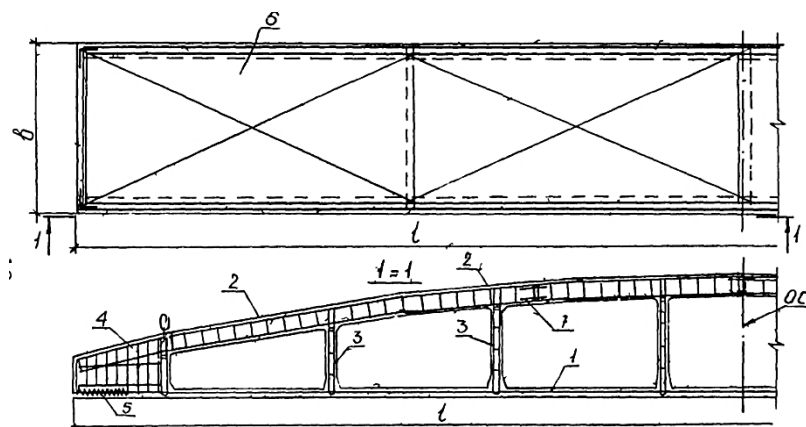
Схема армирования складчатой панели-оболочки КСО:
